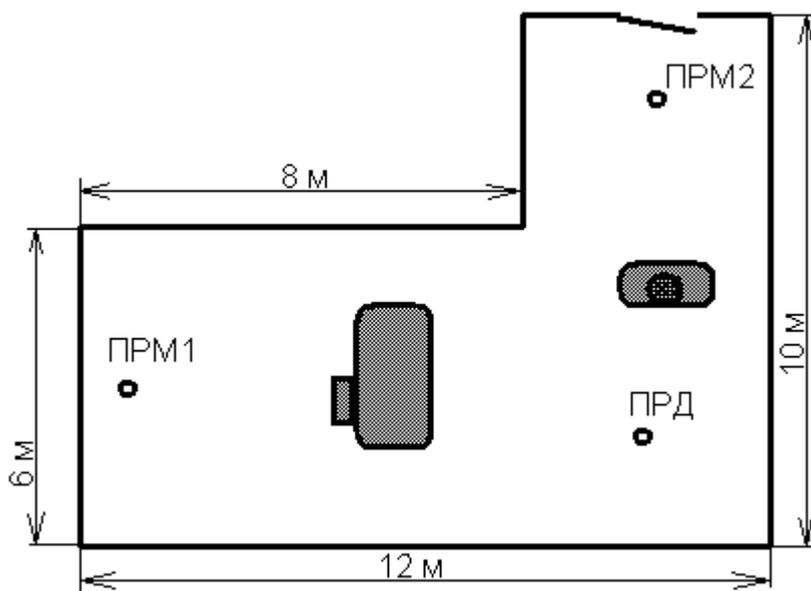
Размещение извещателя на площадке сложной формы с использованием дополнительного ПРМ
